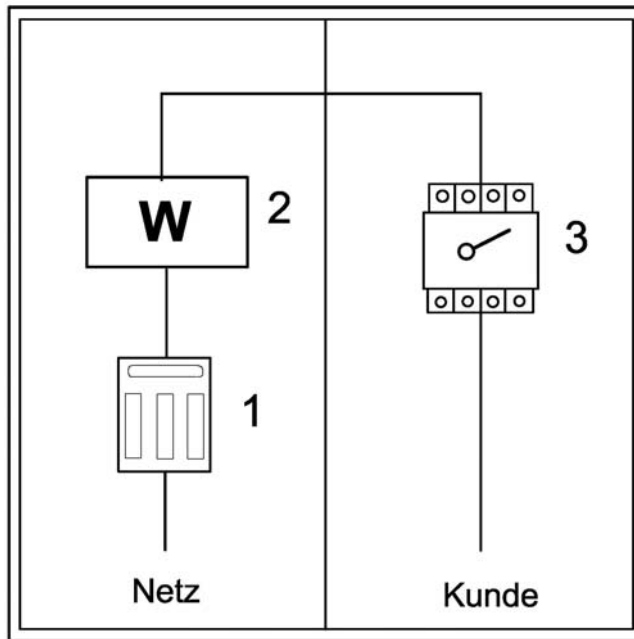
Wandlerschrank für Innenraumwandlermessung bis 400 A
